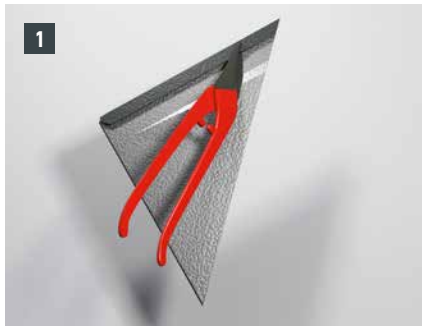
• Dachluke – Besonderheit bei Dachraute 29×29 und 44×44
